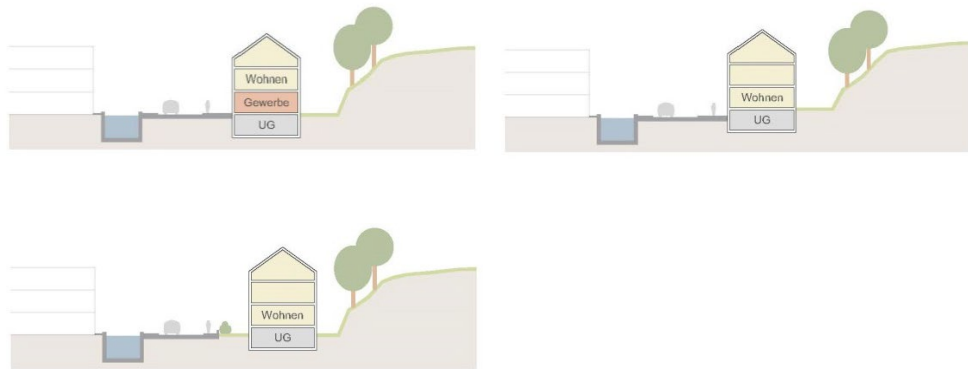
Masterplan Teilplan Bebauung, Metron
